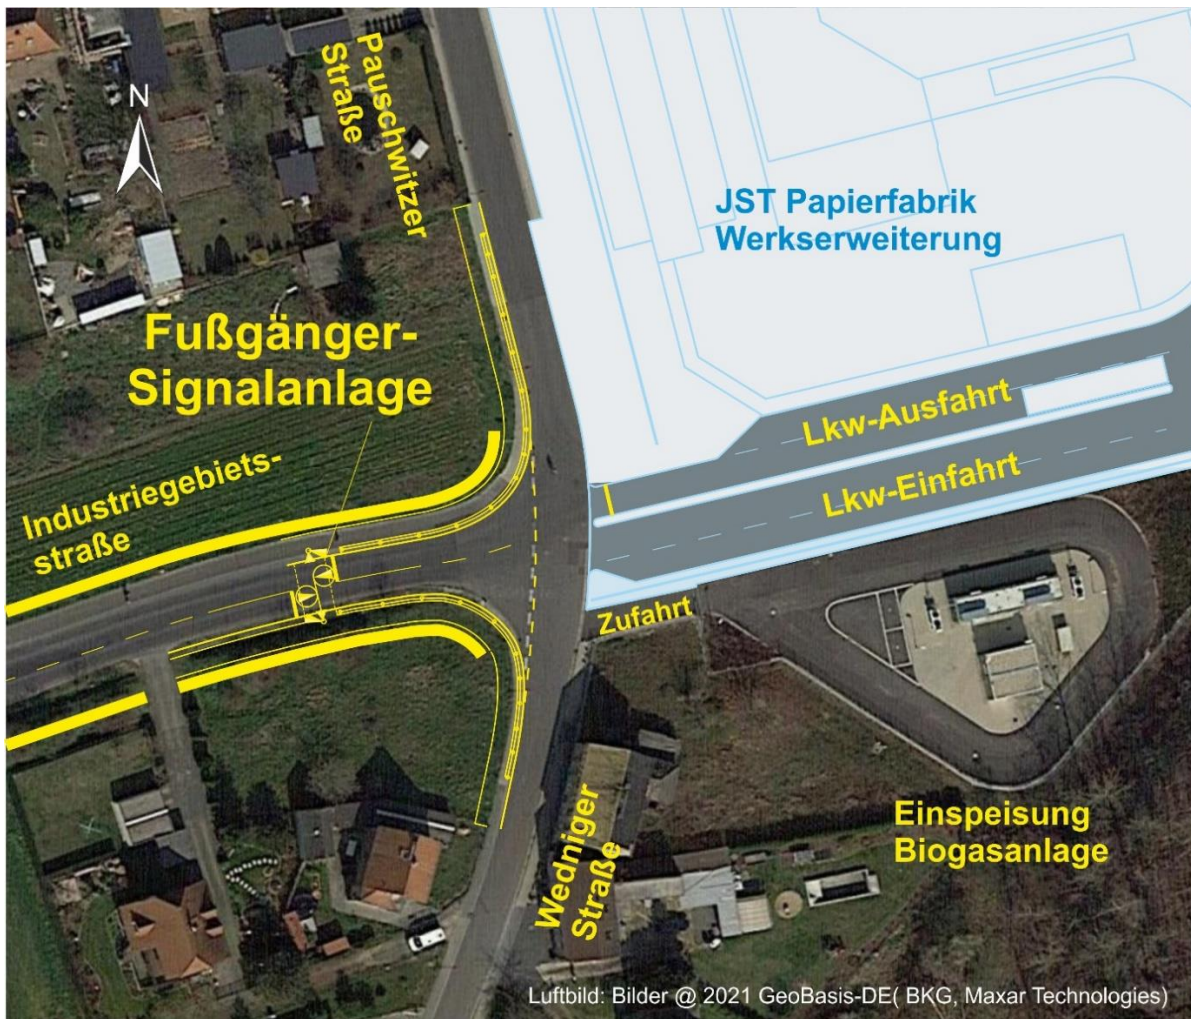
Vorzugsvariante zur Umgestaltung des Knotens Pauschwitzter Straße/Wedniger Straße/Industriegebietsstraße, Quelle [8]
